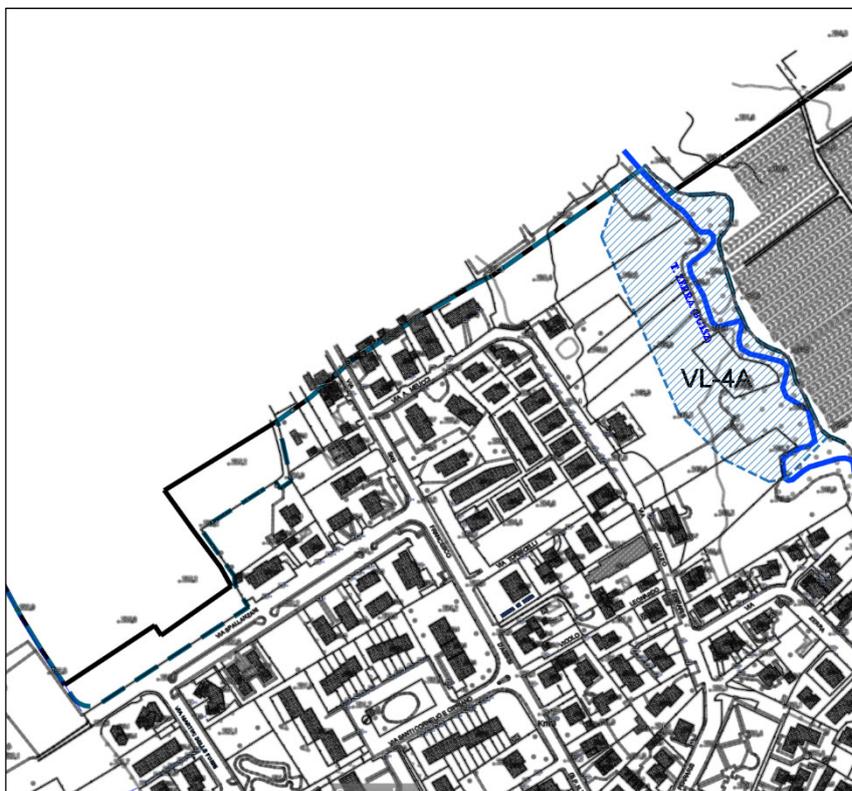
Ubicazione planimetrica della cassa di espansione in linea 4A sul Torrente Zerra.
